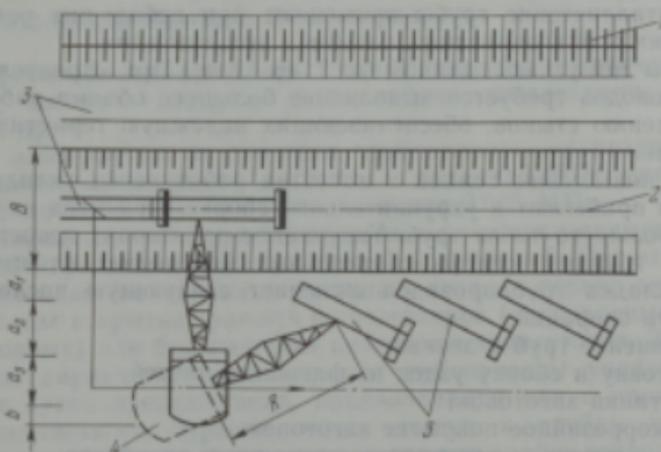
Схема укладки трубопровода из раструбных труб:
